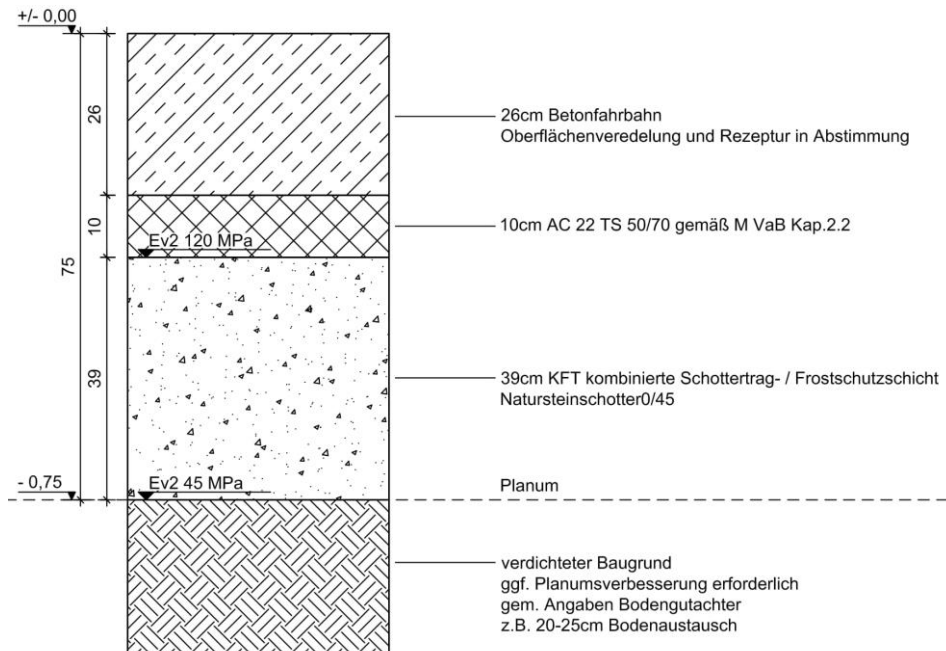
Detail Flächenbelag Ort beton auf Asphalt, Bk100 gem. RStO 12
